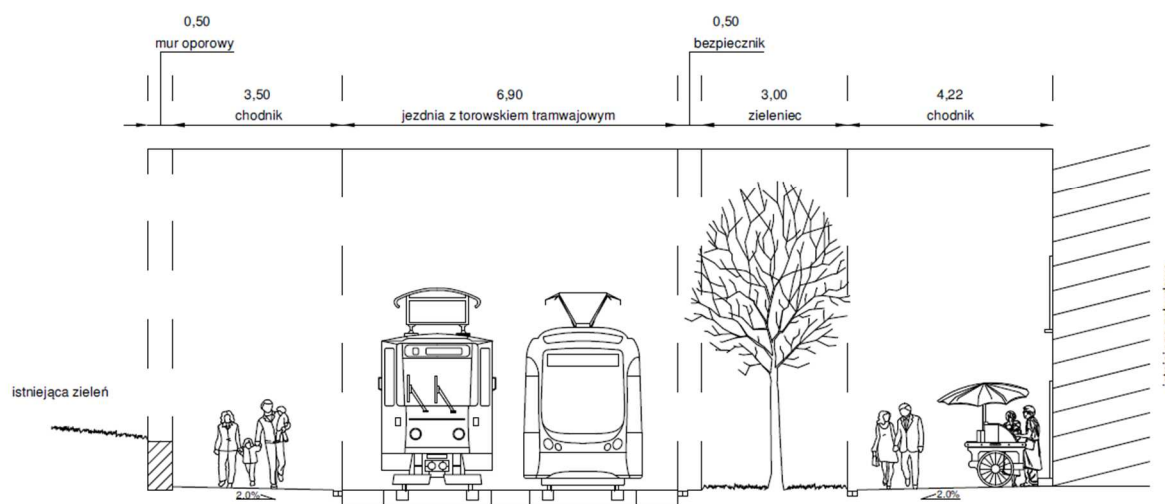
Przekrój konstrukcyjny A-A ul. Straszewskiego
